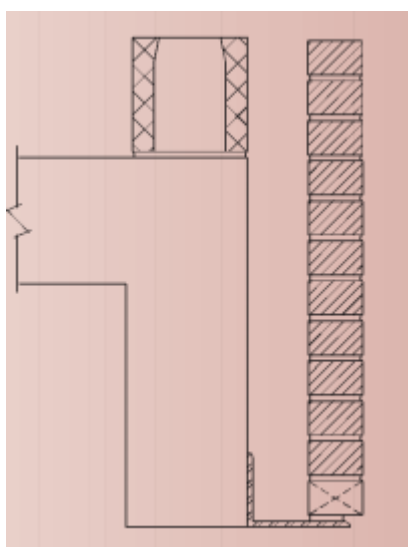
Pormenor arranque do pano exterior em tijolo face à vista a partir de suporte metálico [18]
